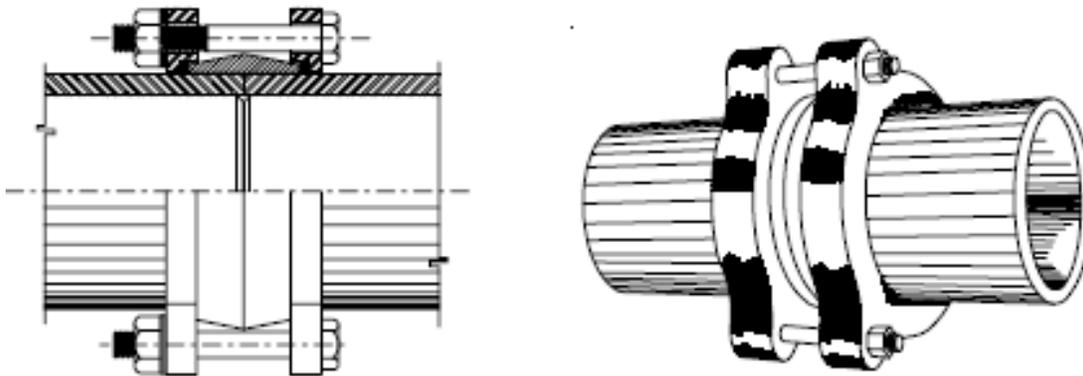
Corte de una junta Gibault armada. Figura 2.9d Junta Gibault
